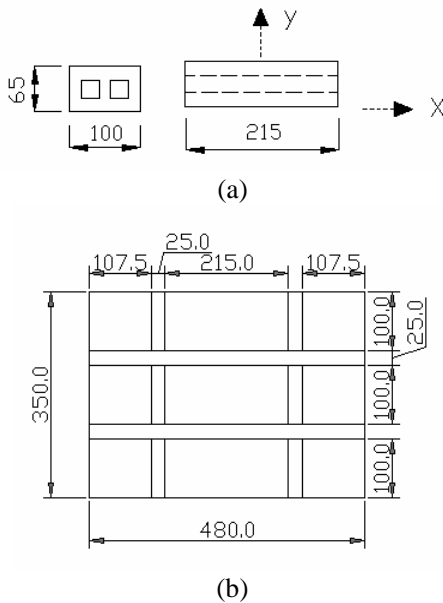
Modelo dos Painéis (dimensões em mm): (a) Direção X e Y dos blocos; (b) Dimensões dos painéis para ensaio ao cisalhamento.
